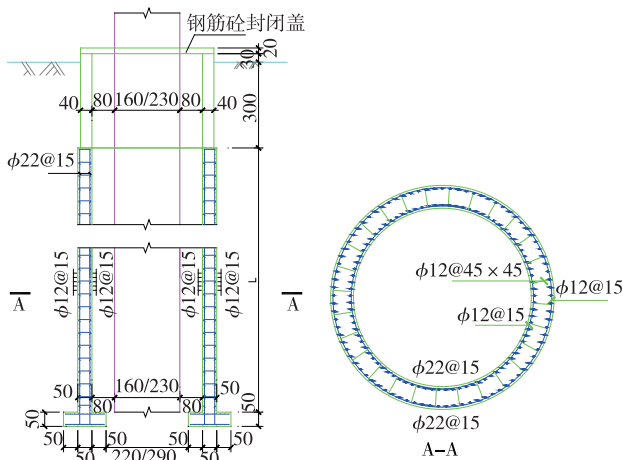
钢筋砼护筒结构示意图(单位:钢筋直径为 mm, 其他为 cm)
